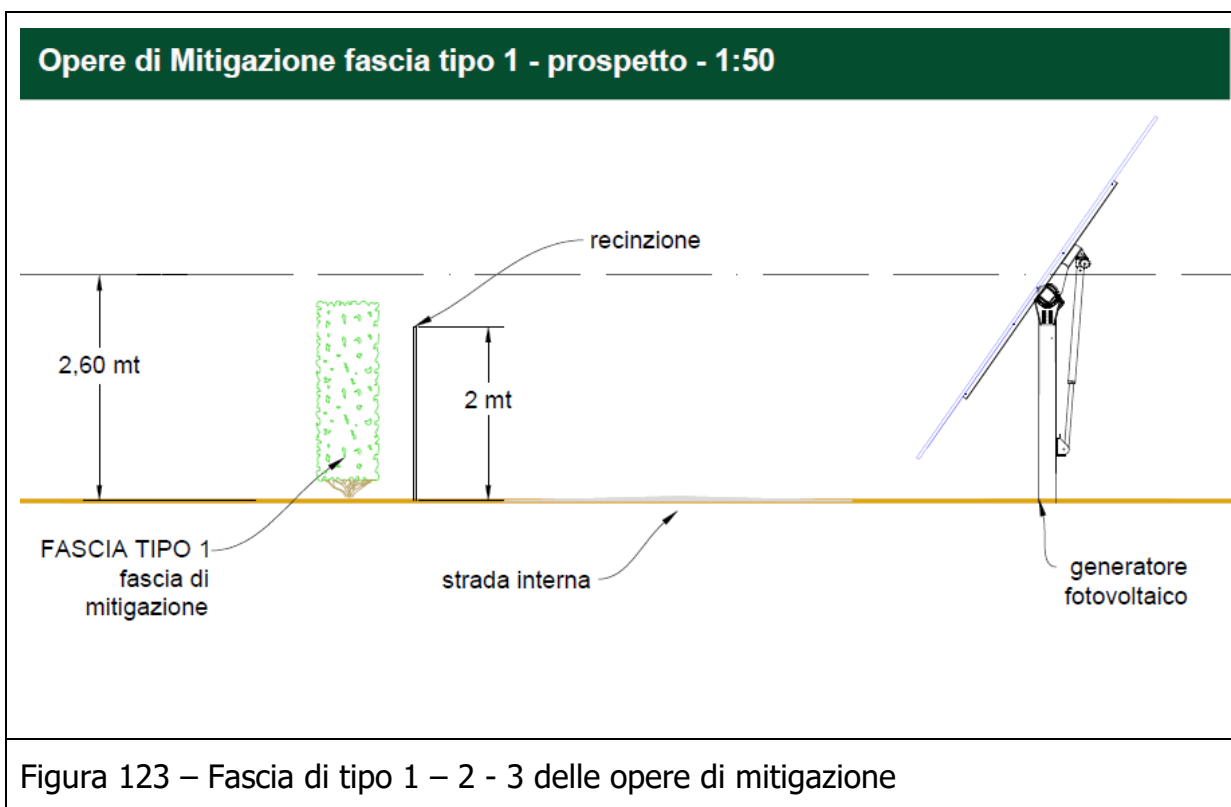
Fascia di tipo 1 – 2 - 3 delle opere di mitigazione
